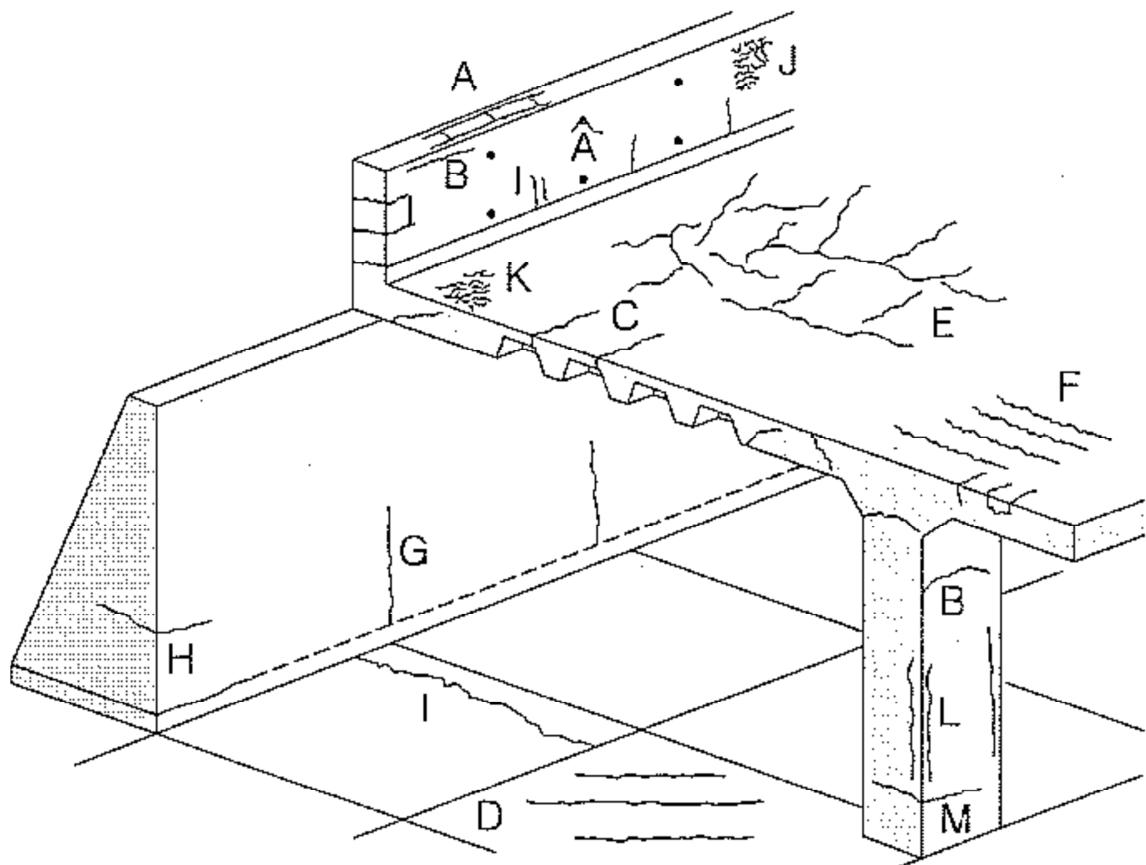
Schéma de fissurations fréquentes dans les ouvrages en béton.
